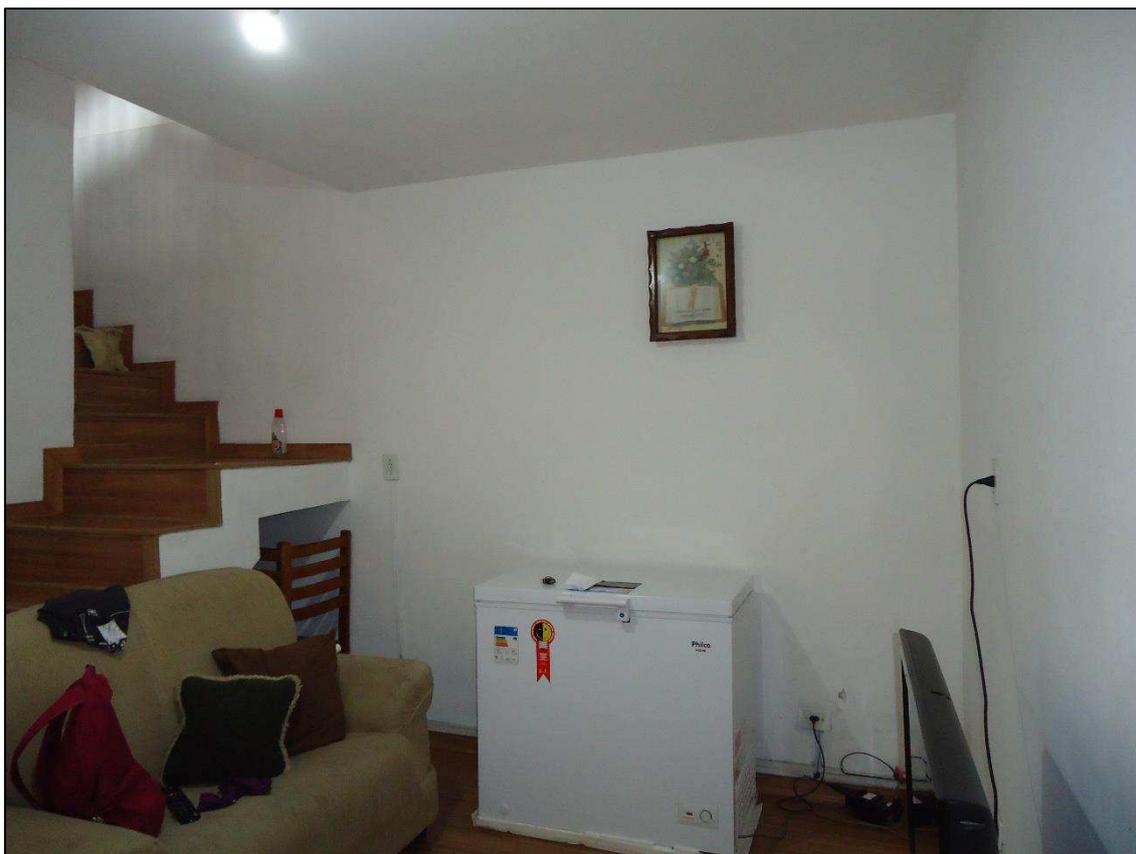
Vista da sala e escada de acesso ao pavimento superior.
